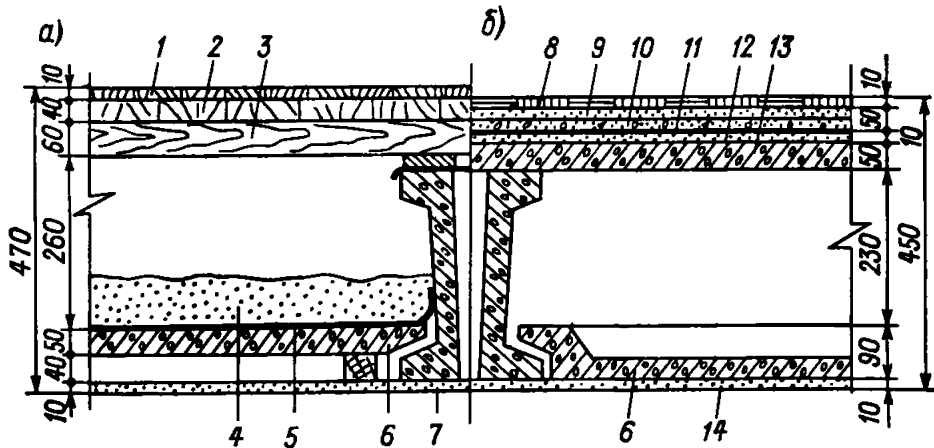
Перекрытие по железобетонным балкам швеллерного сечения
